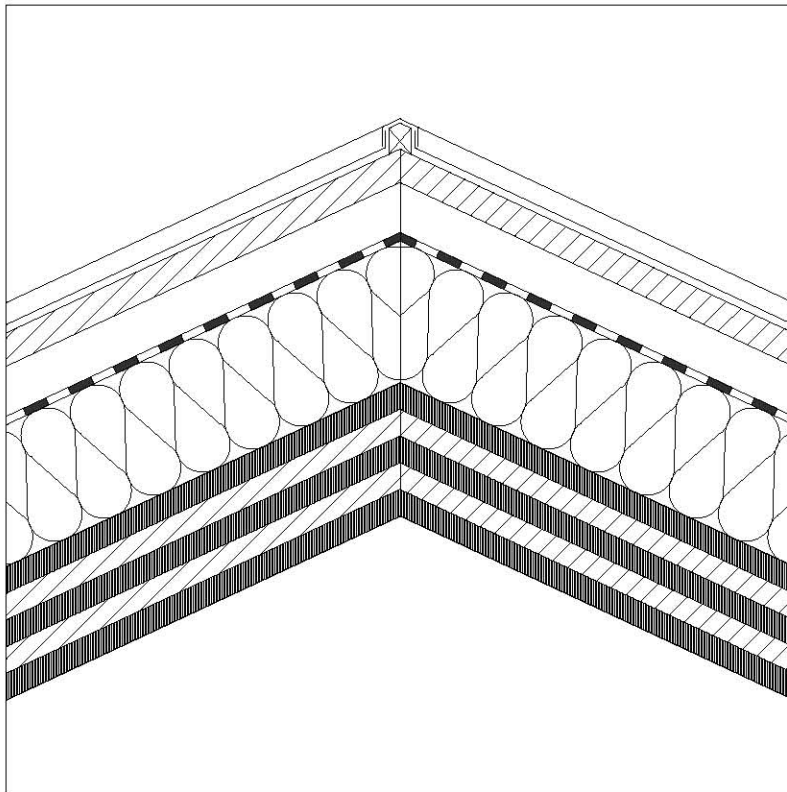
SISTEMA MACIÇO, PORMENOR TELHADO, ESCALA 1:10.
